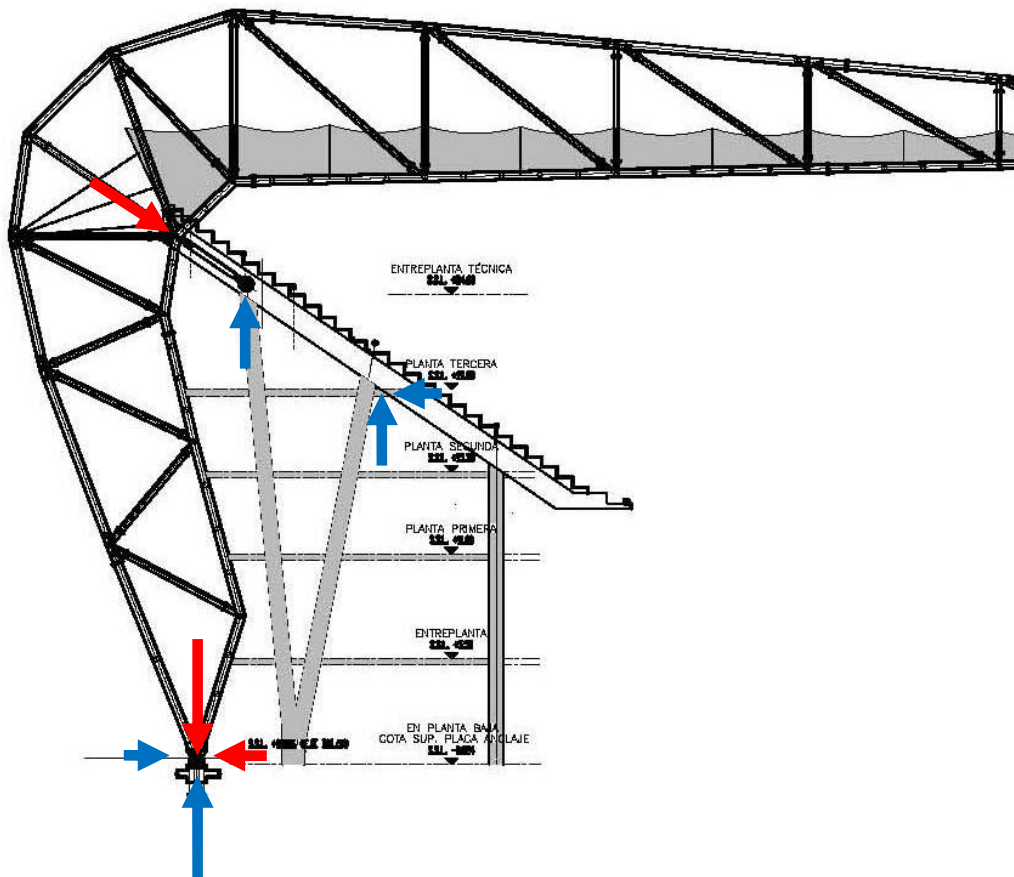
Diagrama de transmisión de las fuerzas a la estructura de hormigón.
